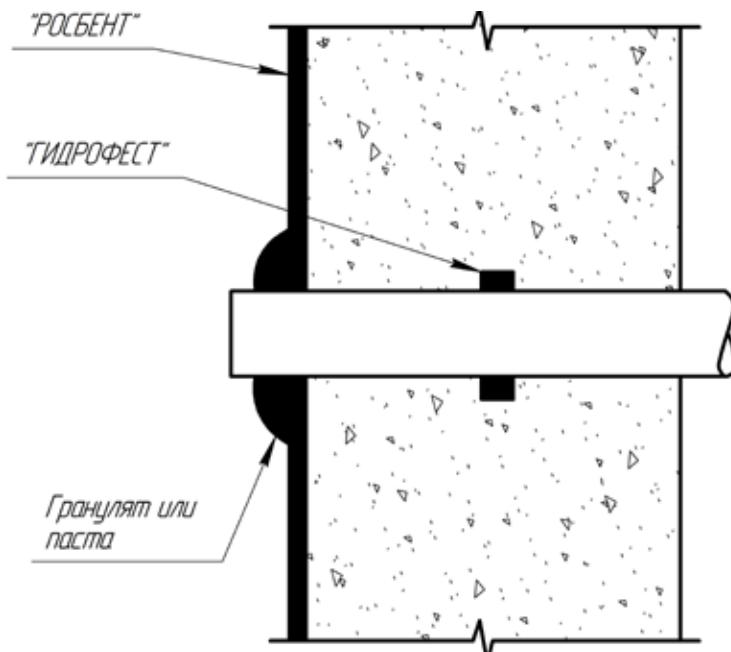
Гидроизоляция отдельной конструкции проходящей через стену
